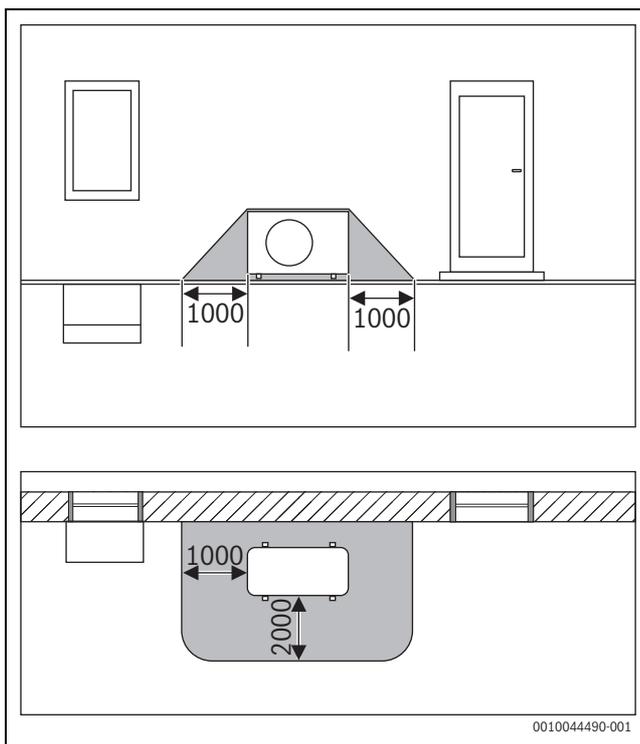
Área de proteção, unidade exterior de chão numa parede (dimensões em mm)
